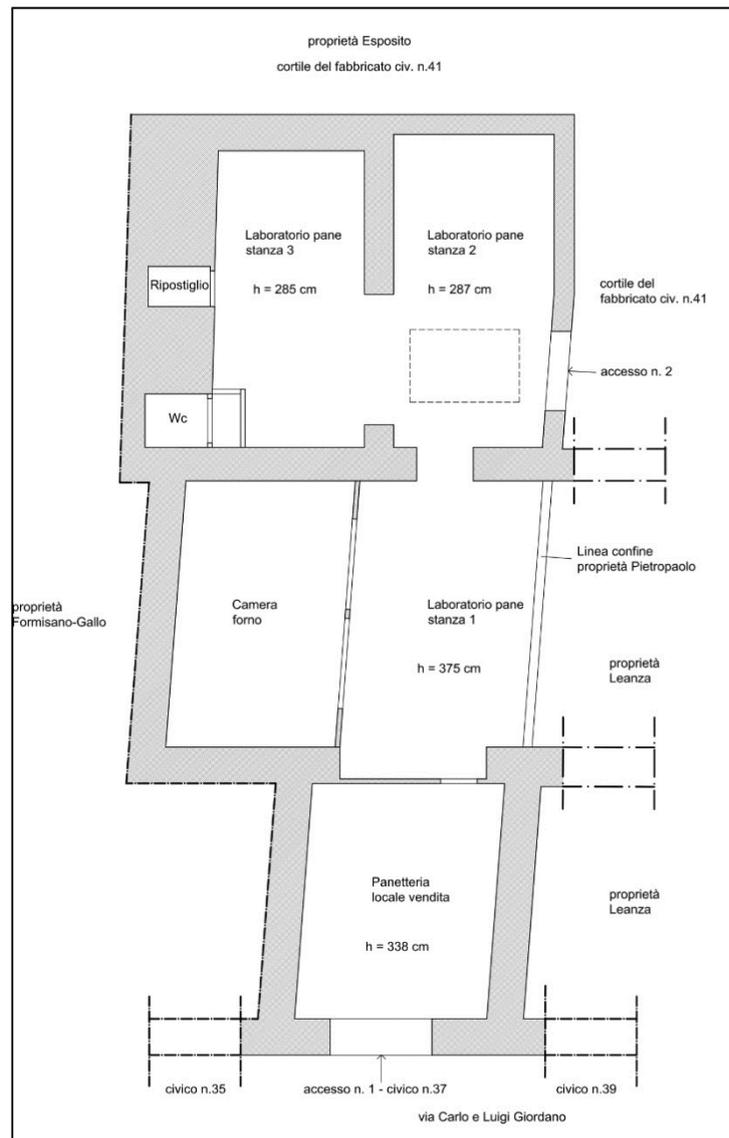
a\_Planimetria di stato attuale del locale/laboratorio di via Giordano n.37
